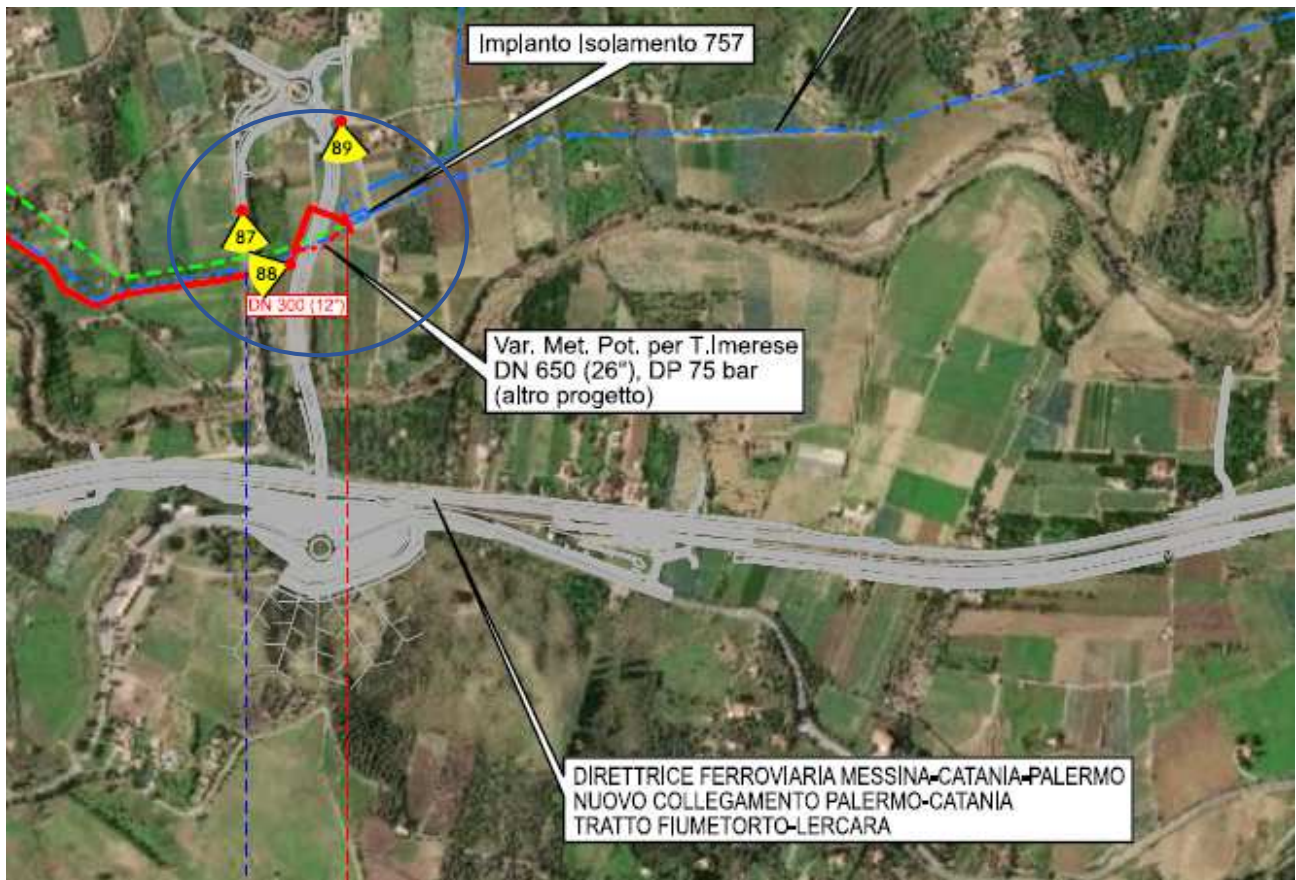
Planimetria con visualizzata la Variante n. 8.
